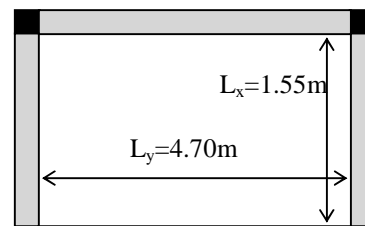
Schéma d'une dalle sur trois appuis.
